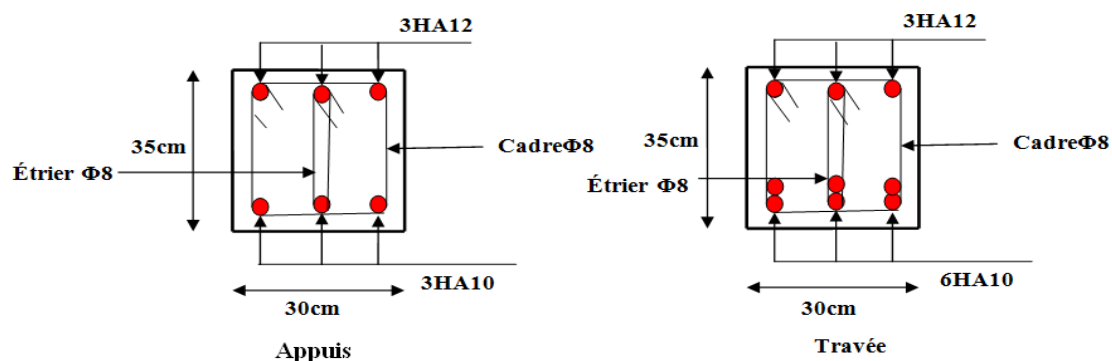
Schéma de ferrailage de la poutre de chaînage
